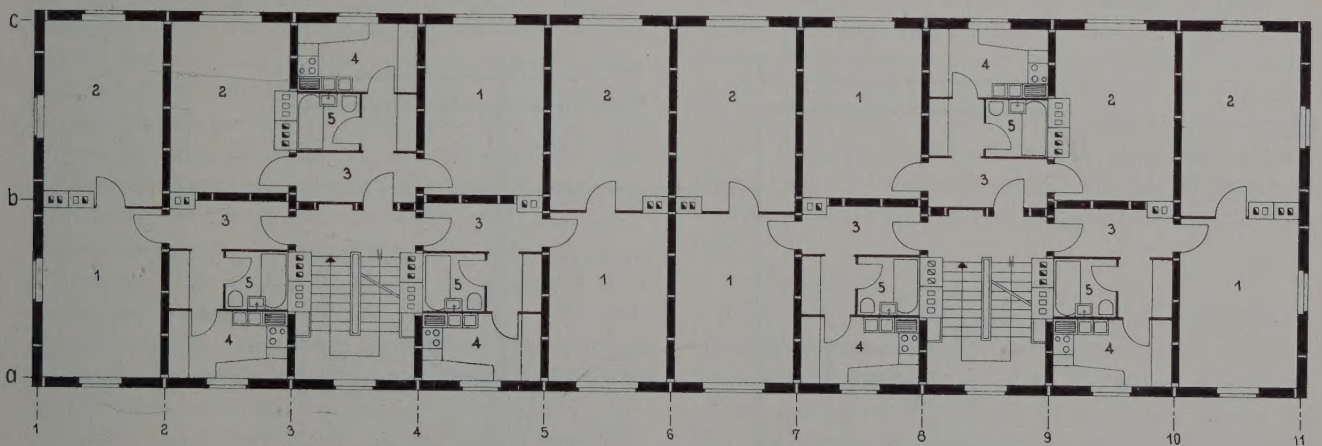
Dreispannergrundriß mit 3 Zweizimmerwohnungen für Querwandbauweise
